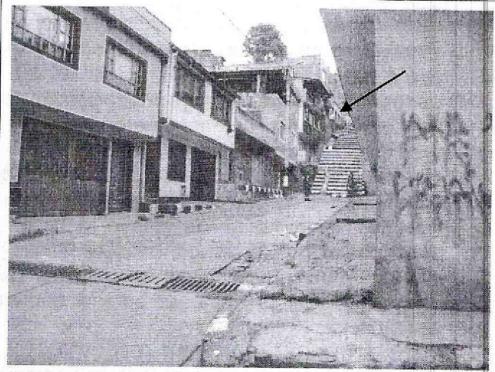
Vista del sector donde se localiza el proyecto de la Diagonal 49D Sur # 16H-34.
